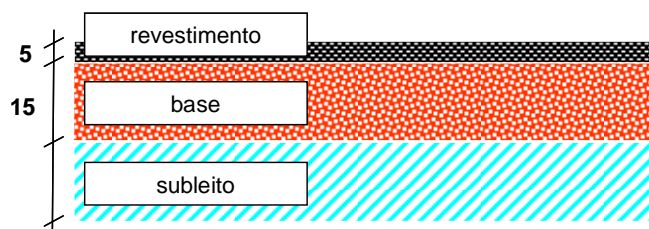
Estrutura do pavimento executado em Extrema - MG
